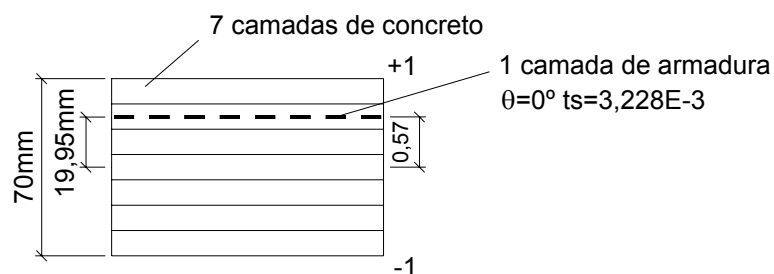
Camadas de aço e concreto da laje da viga mista contínua B1 e B2
